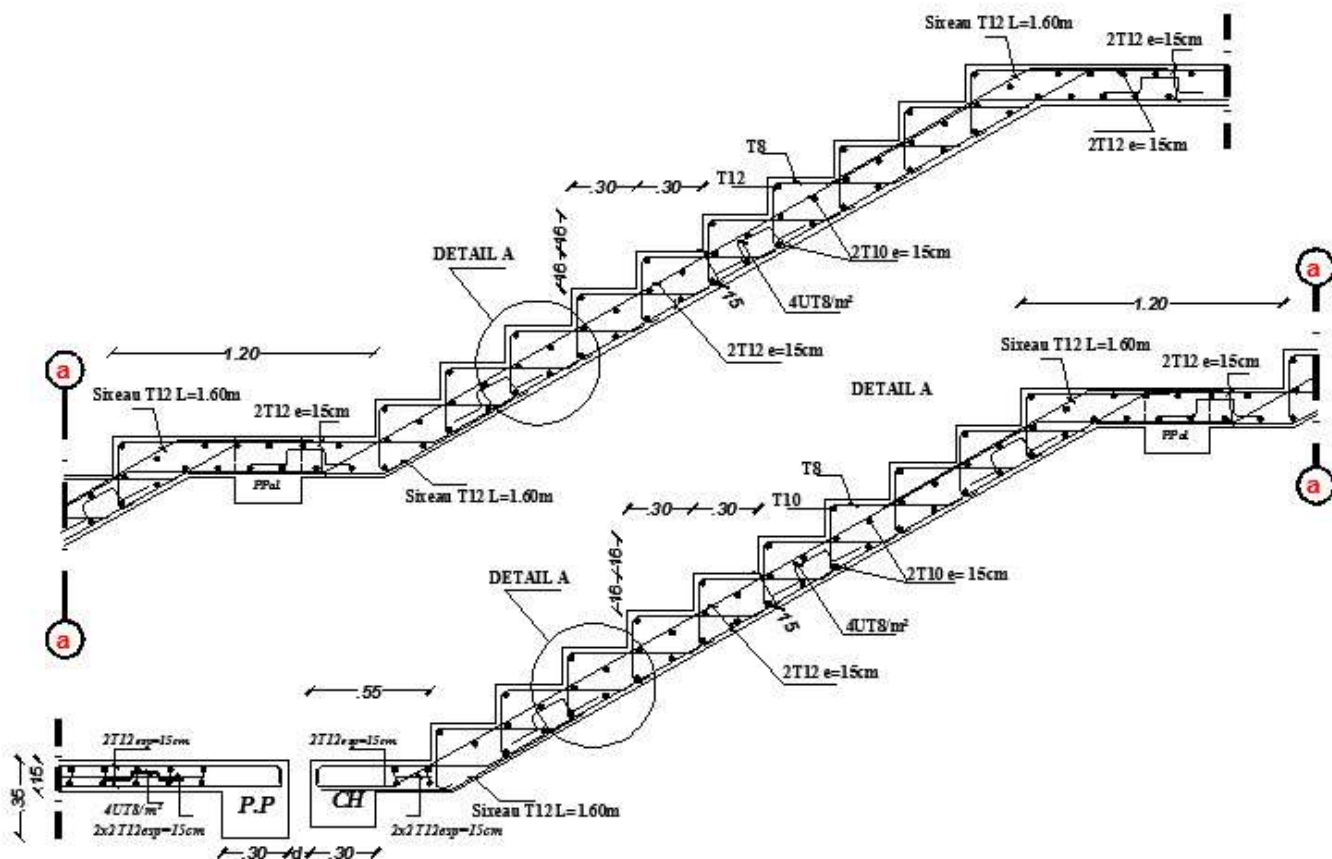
Coffrage et ferrailage de l'escalier type 1
